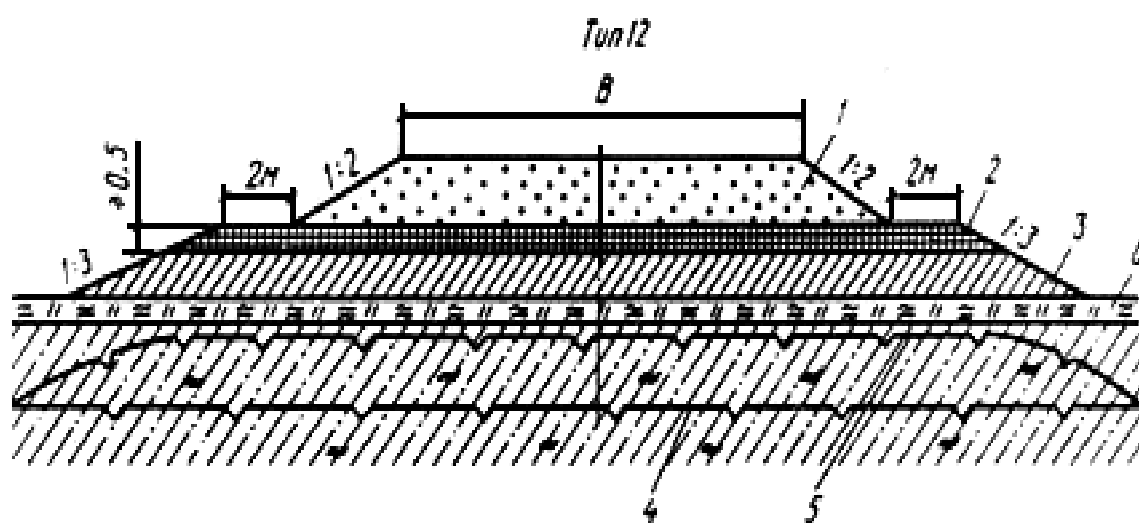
Поперечный профиль насыпи с бермами на участках с грунтами III–IV категорий просадочности:
